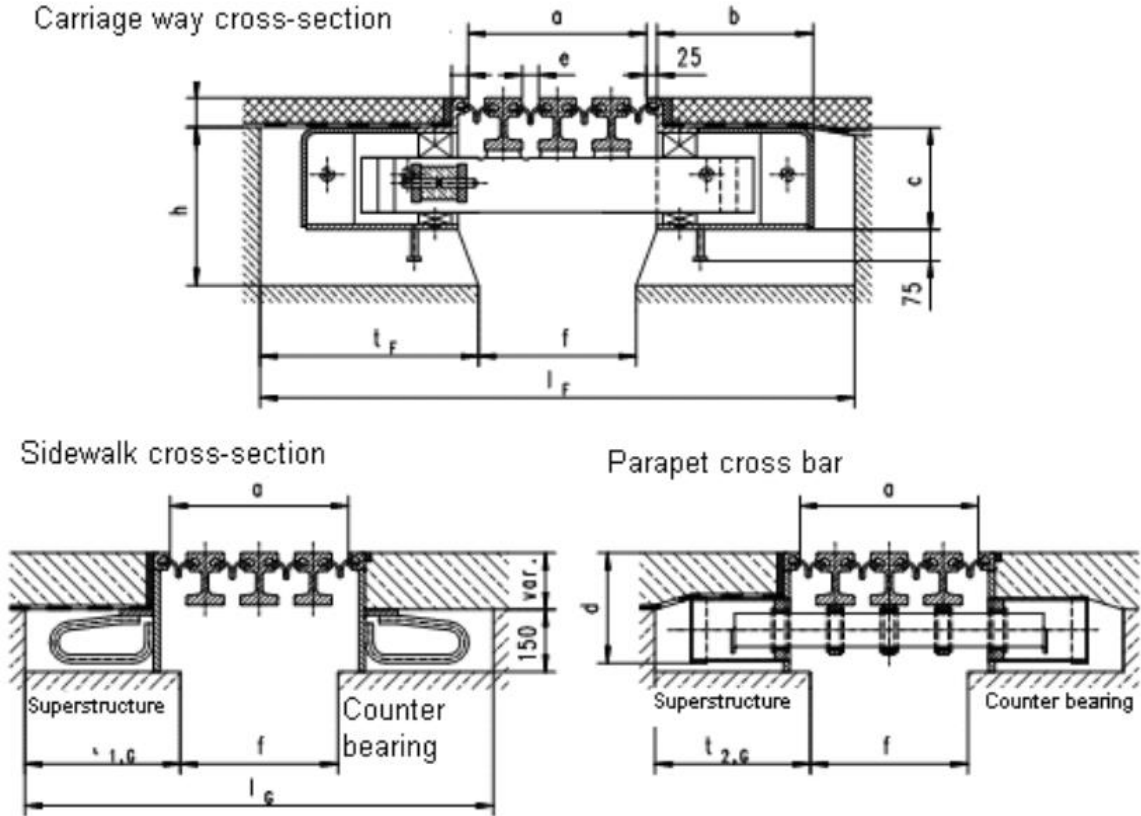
Coupe transversale – Zone chaussée et trottoir
